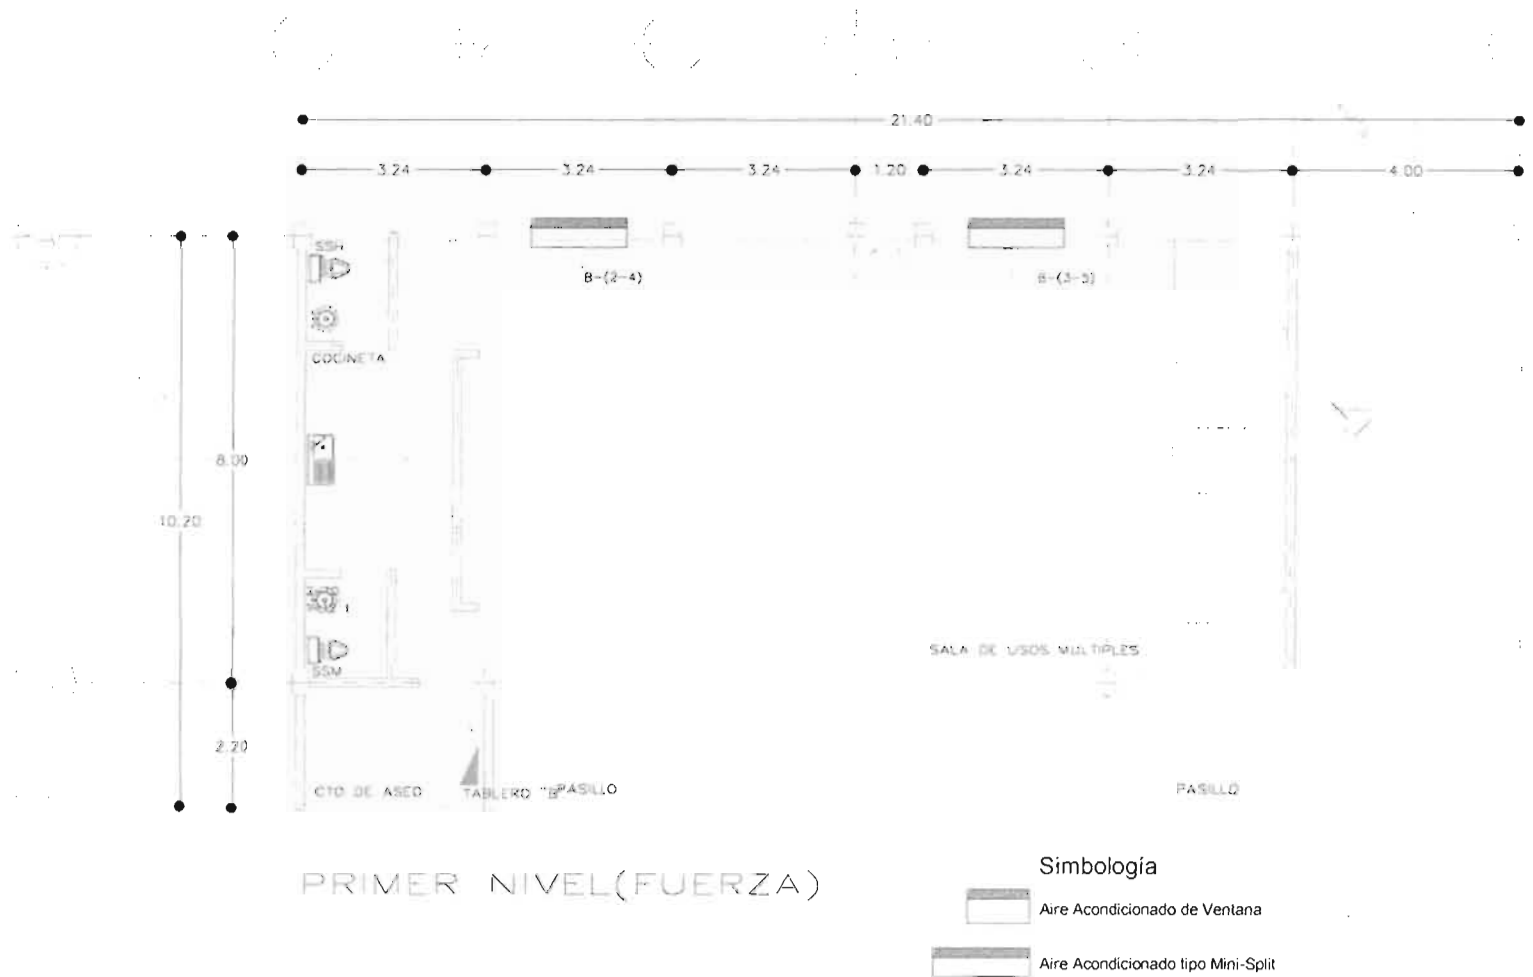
Plano de Aires de la Primer Nivel del Edificio B.
